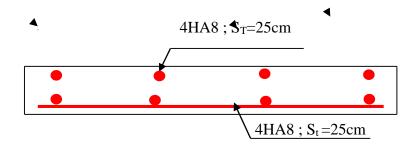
Schéma de ferraillage de la dalle sur 4 appuis
